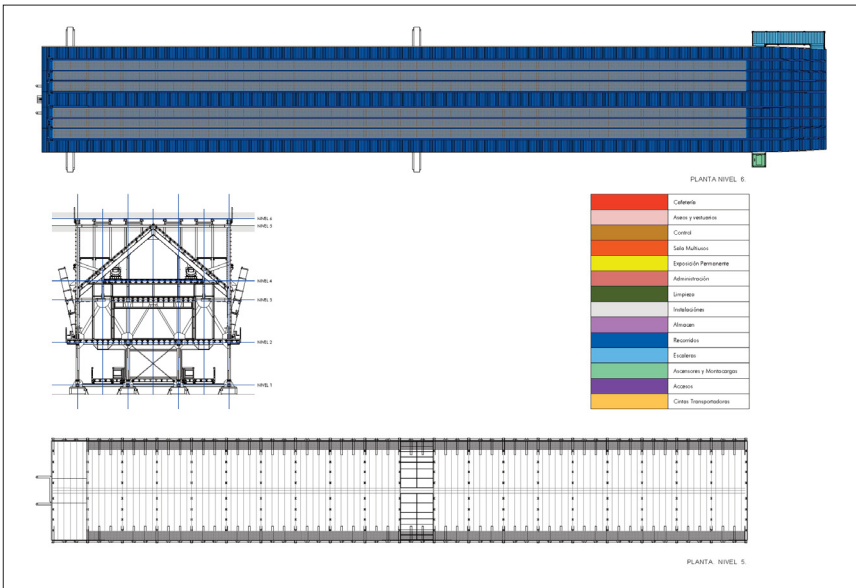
Plantas niveles 5-6, Almería, 2009. Elaboración propia.
